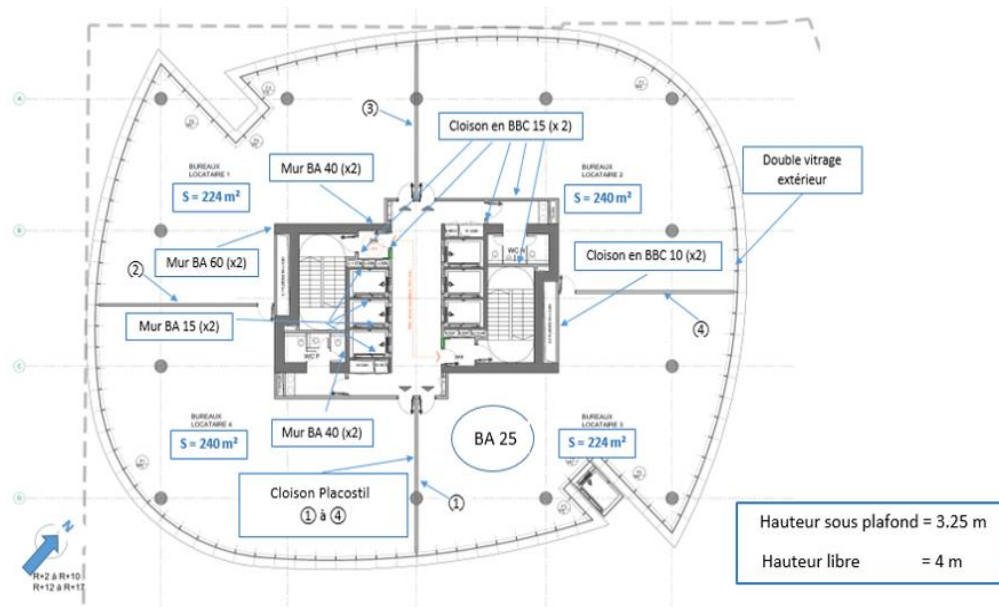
Plan du Bureau Type et de ses ouvrages élémentaires
